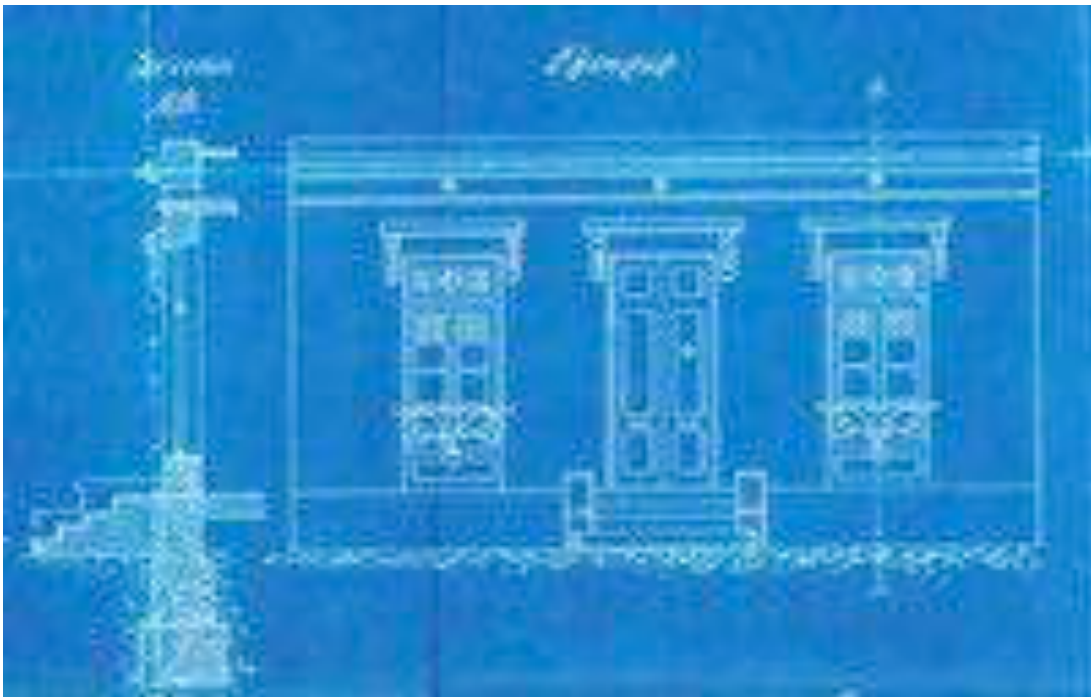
‘Plano de emplazamiento’ (Fragmento de fachada y sección). Víctor Beltrí. ACMF CB 173/1.
